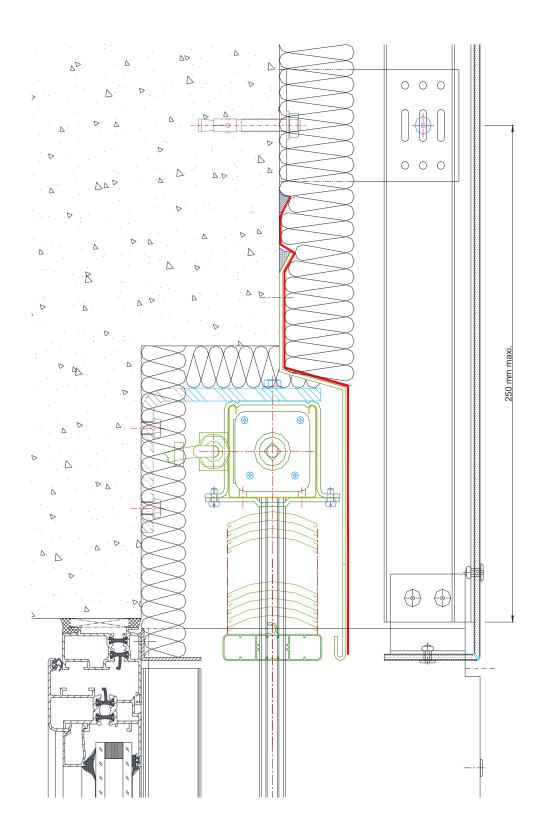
Linteau de baie - Coupe verticale - Système riveté RV 60 4c
